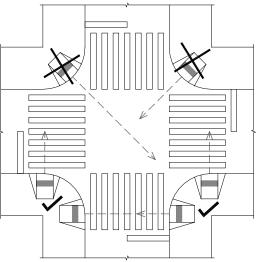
Recomendação para instalação da travessia de pedestres em esquinas
